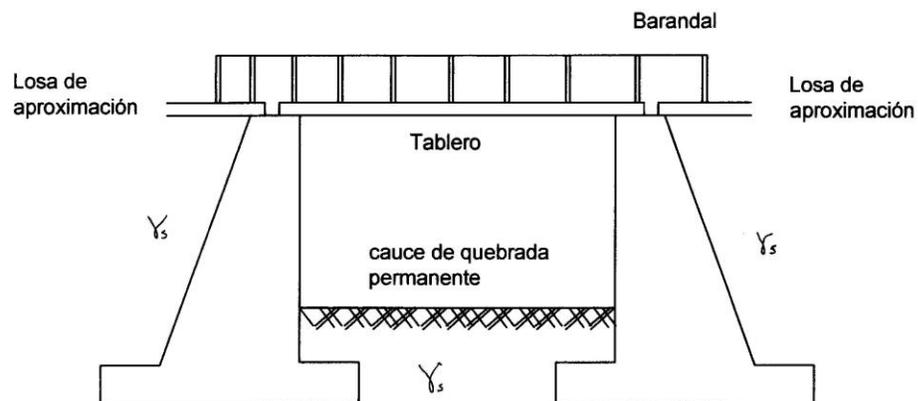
Mecanismo de funcionamiento de muros estribos de mampostería de piedra en puentes
